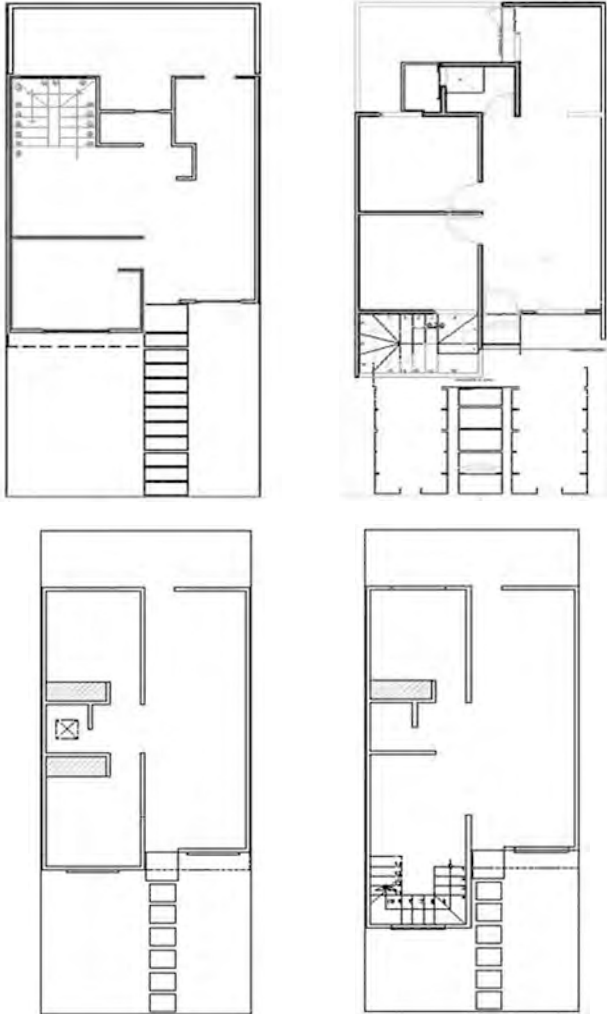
Se muestran cuatro plantas arquitectónicas de fraccionamientos de interés social y medio en la ciudad donde se observa cómo se agudiza el problema de la pobre resistencia de la mampostería con la escasa cantidad de muros en la dirección x de las viviendas.
